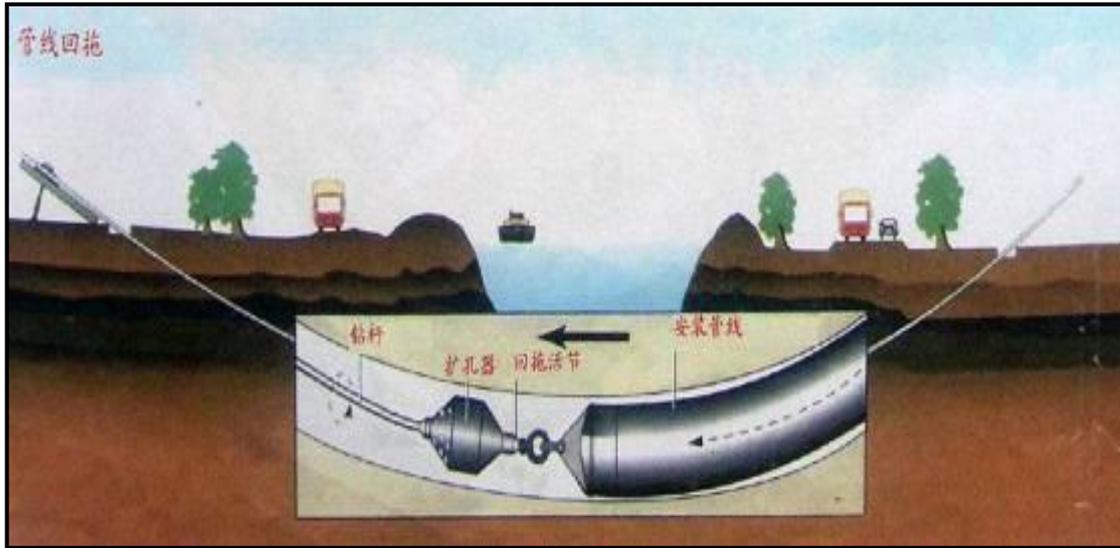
定向钻穿越施工管线回拖过程断面示意图
